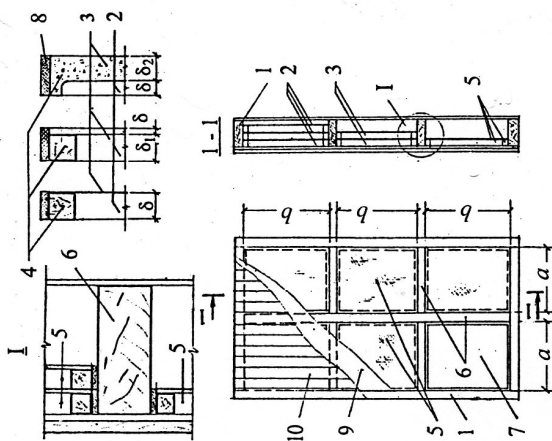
Каркасно-щитовая панель с теплоизолирующими модулями
